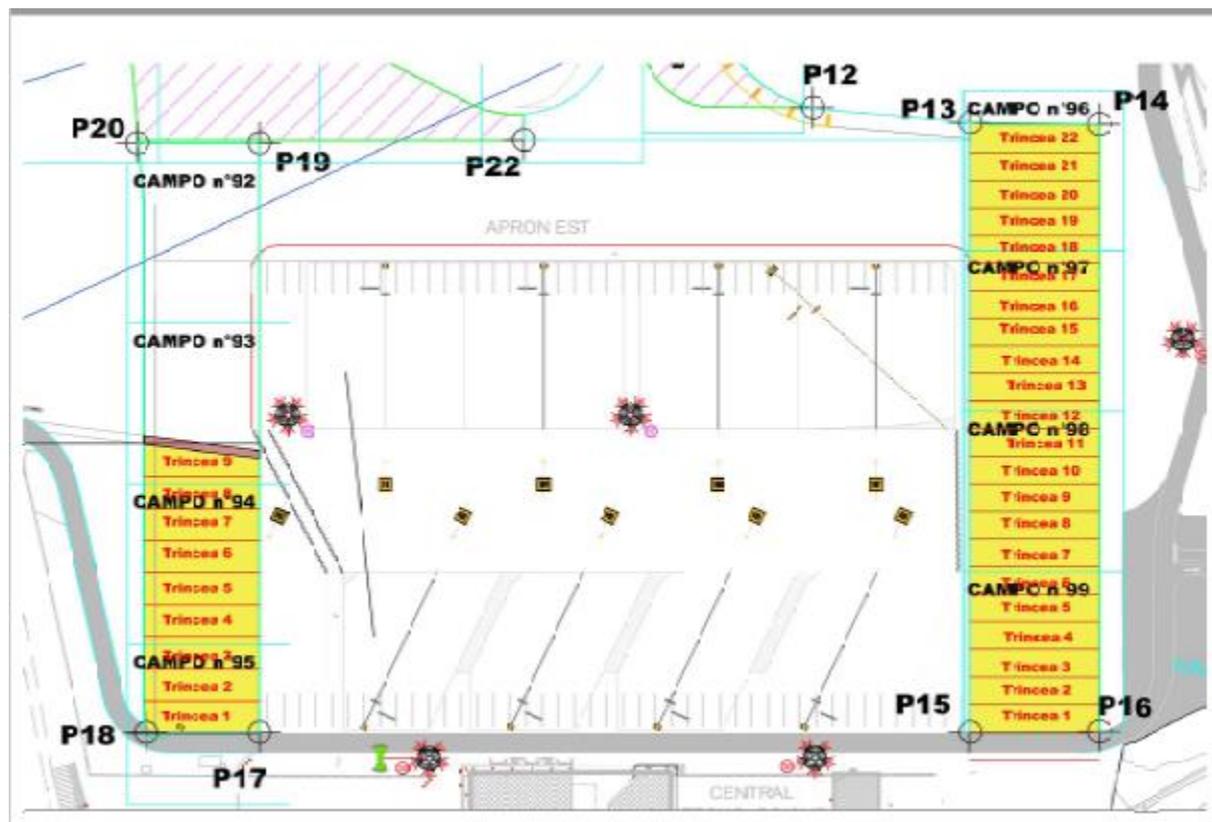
Planimetria dell'apron est, posizionamento trincee.
